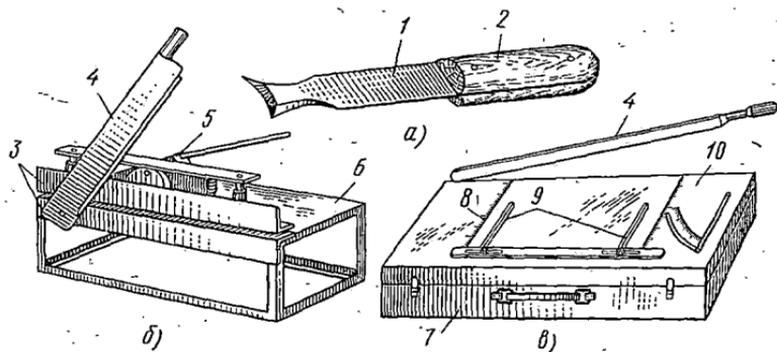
Инструменты и приспособления для резки поливинилхлоридных плиток:
